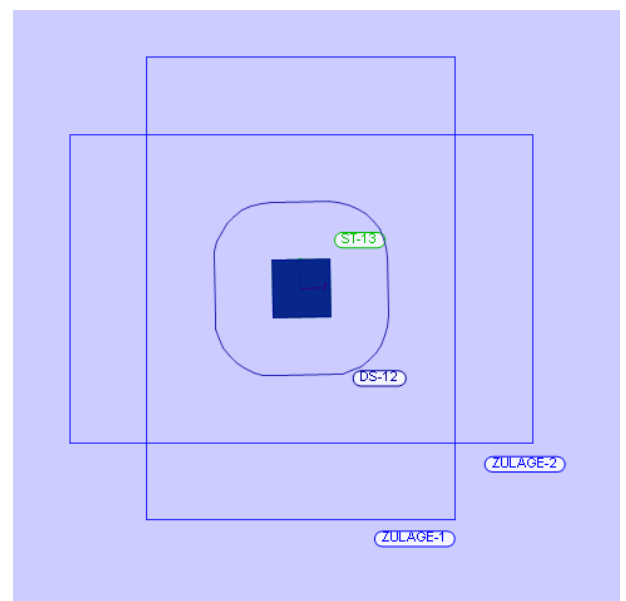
Durchstanzstelle mit Bewehrungszulagen
